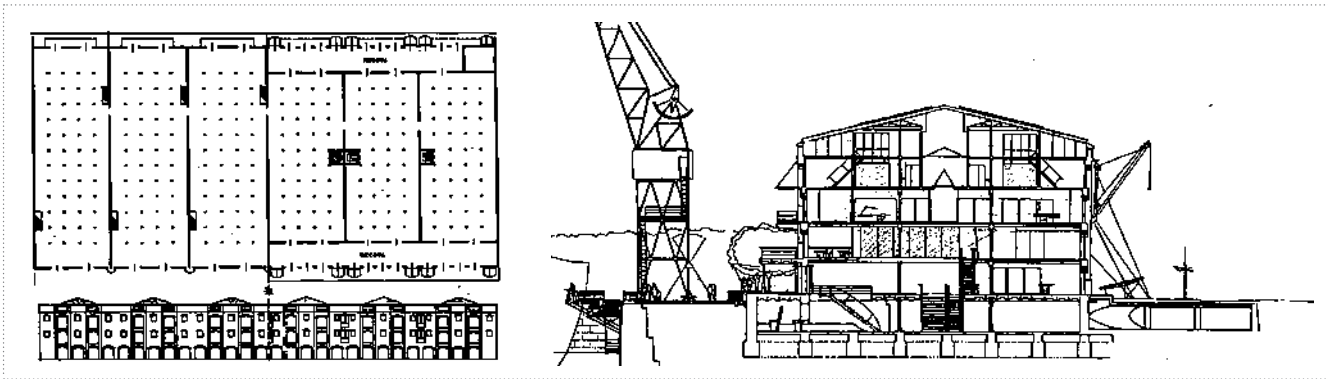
Corte transversal, planta baixa e fachada e de um depósito portuário antes da revitalização.
